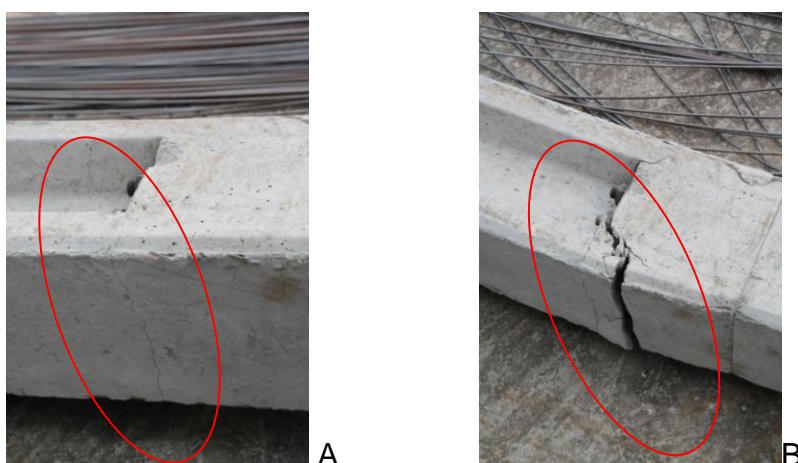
Fissuras superficiais (a) e estrutura rompida na seção maciça (b)
